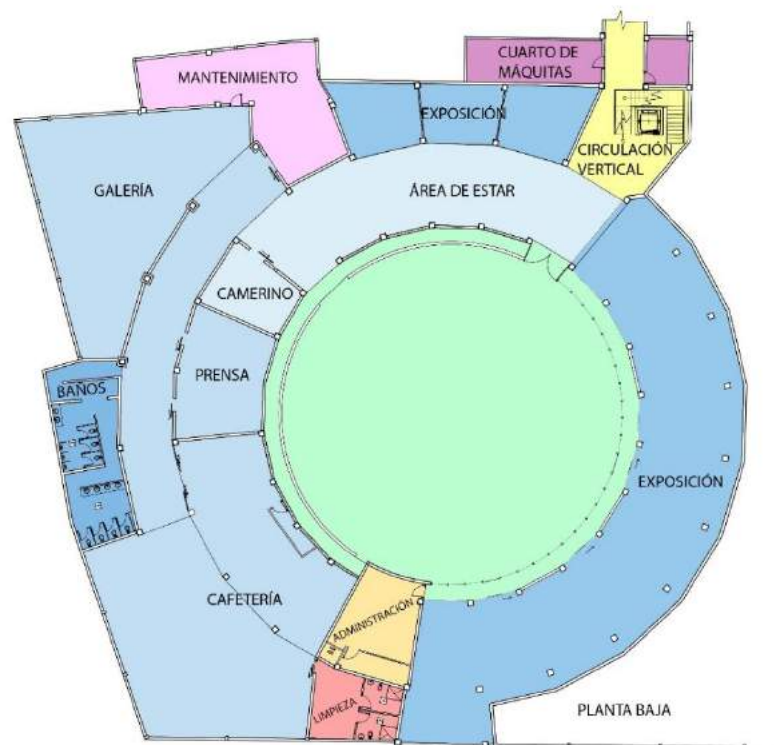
Zonificación planta baja, plaza de toros Belmonte
